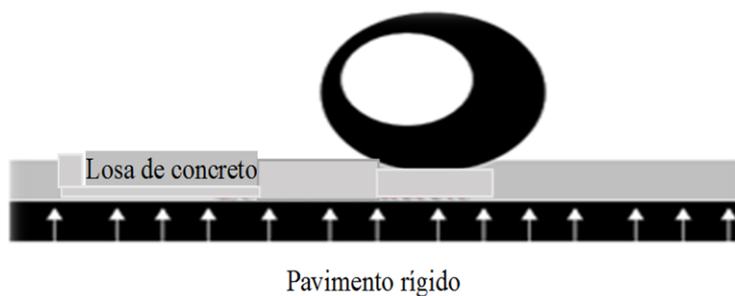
Esquema de comportamiento del Pavimento rígido
